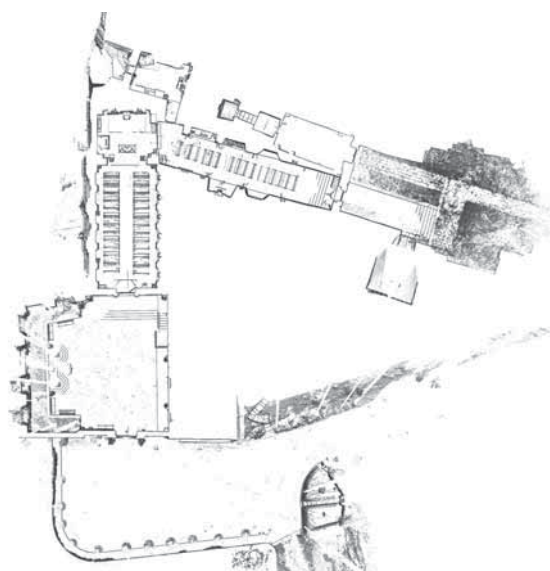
Pianta e prospetto della Chiesa della Palomba
